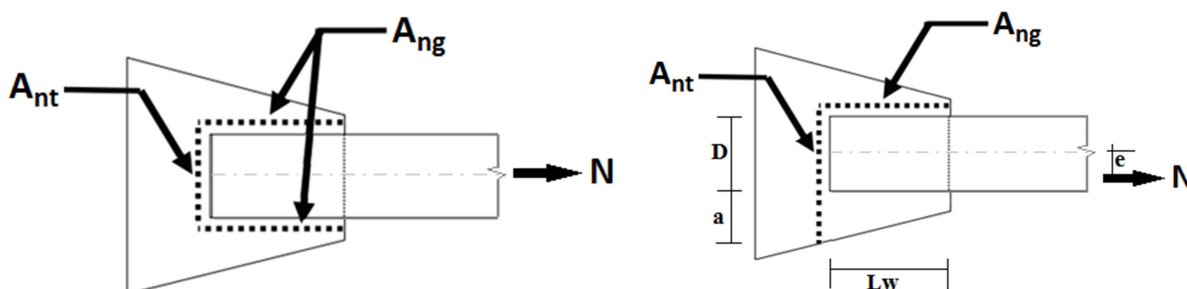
Destacamento do bloco. a): planos de rotura; b): planos de rotura considerando excentricidade acidental
